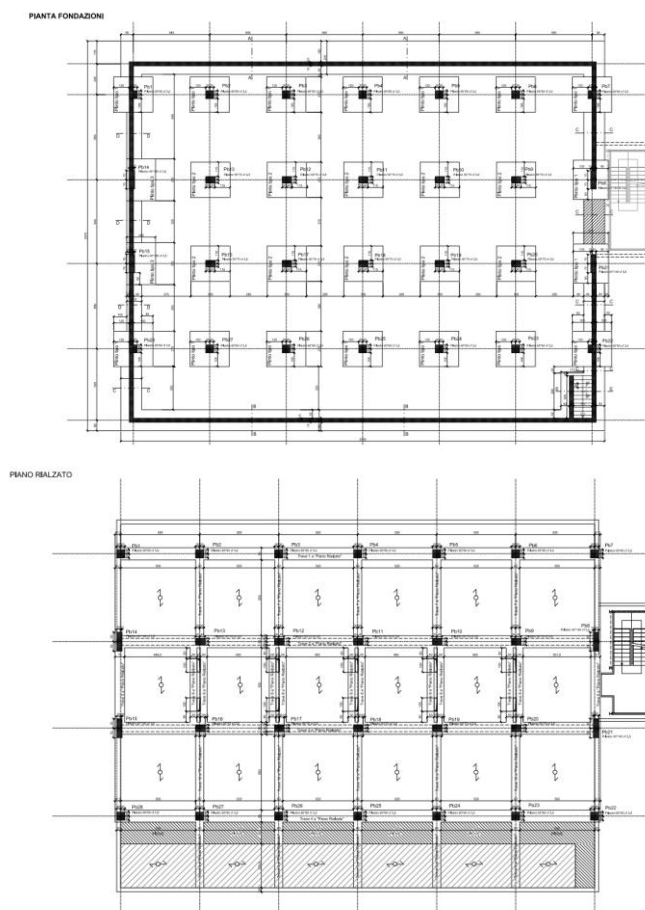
Pianta fondazioni (sinistra) e piano rialzato (destra) corpo B
